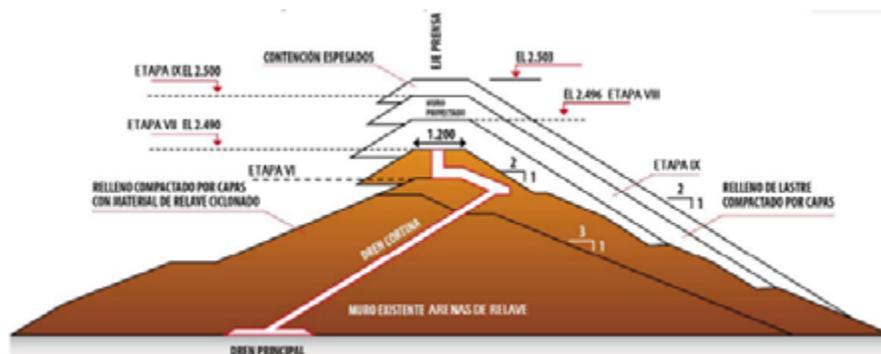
Sección Tipo Muro Depósito de Relaves Talabre
